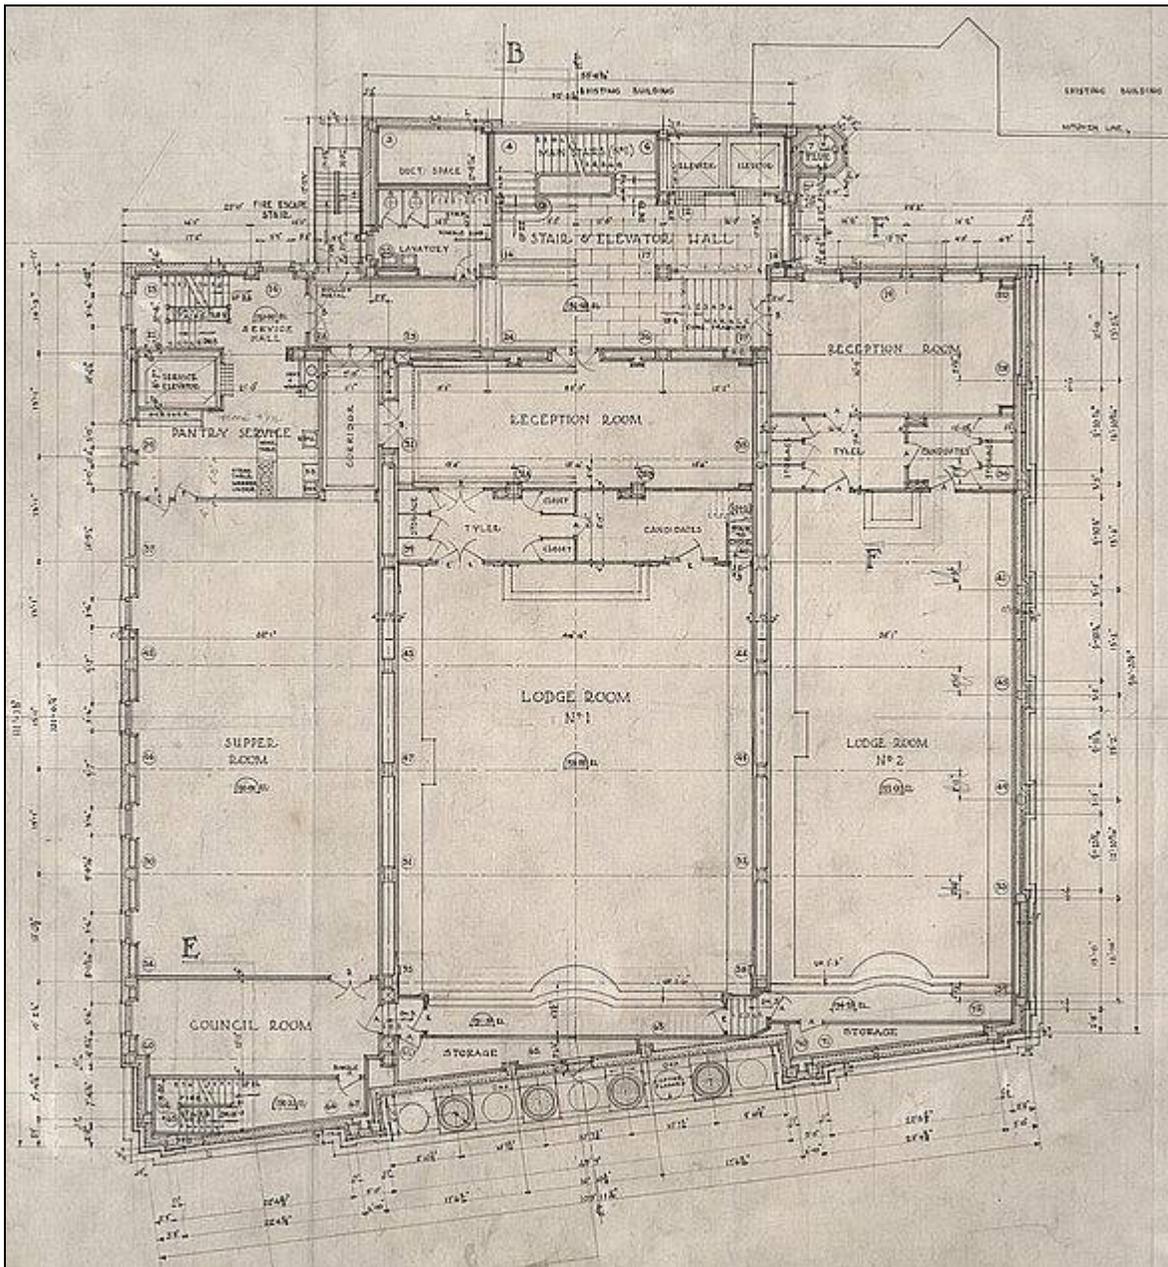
Plan du *first floor*, ou étage n° 5 (détail de la feuille du plan).
